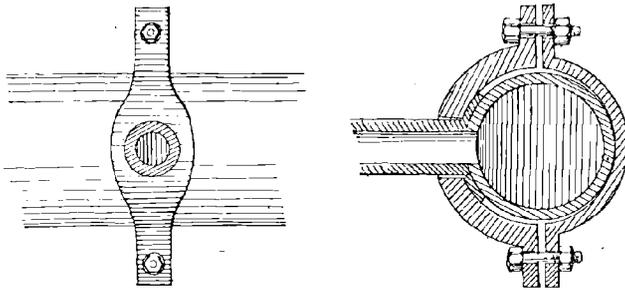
Branchement d'une conduite en plomb sur une conduite en fonte.
